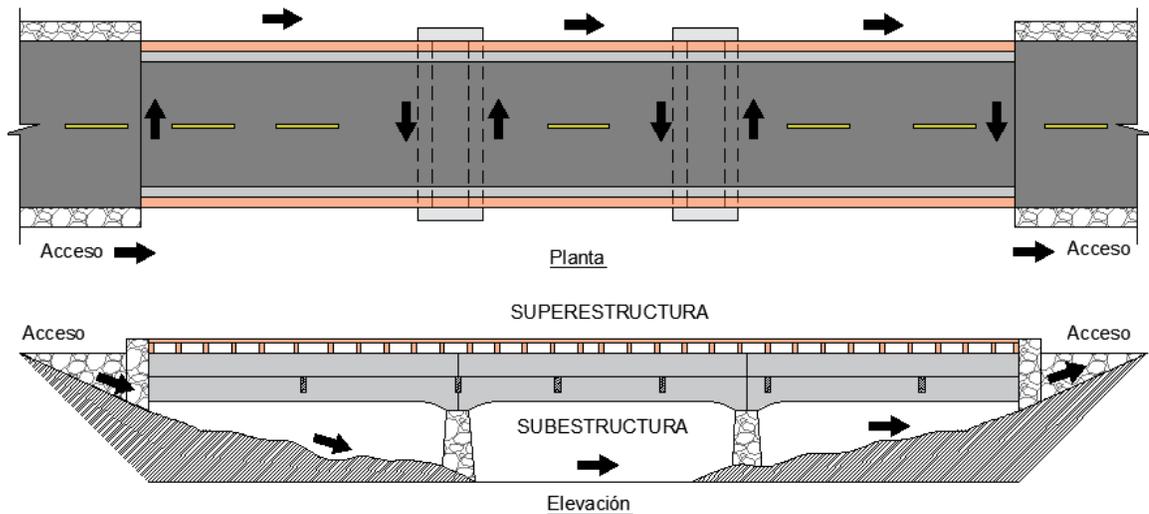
Diagrama de recorrido de inspección de elementos de puentes, subestructura.
